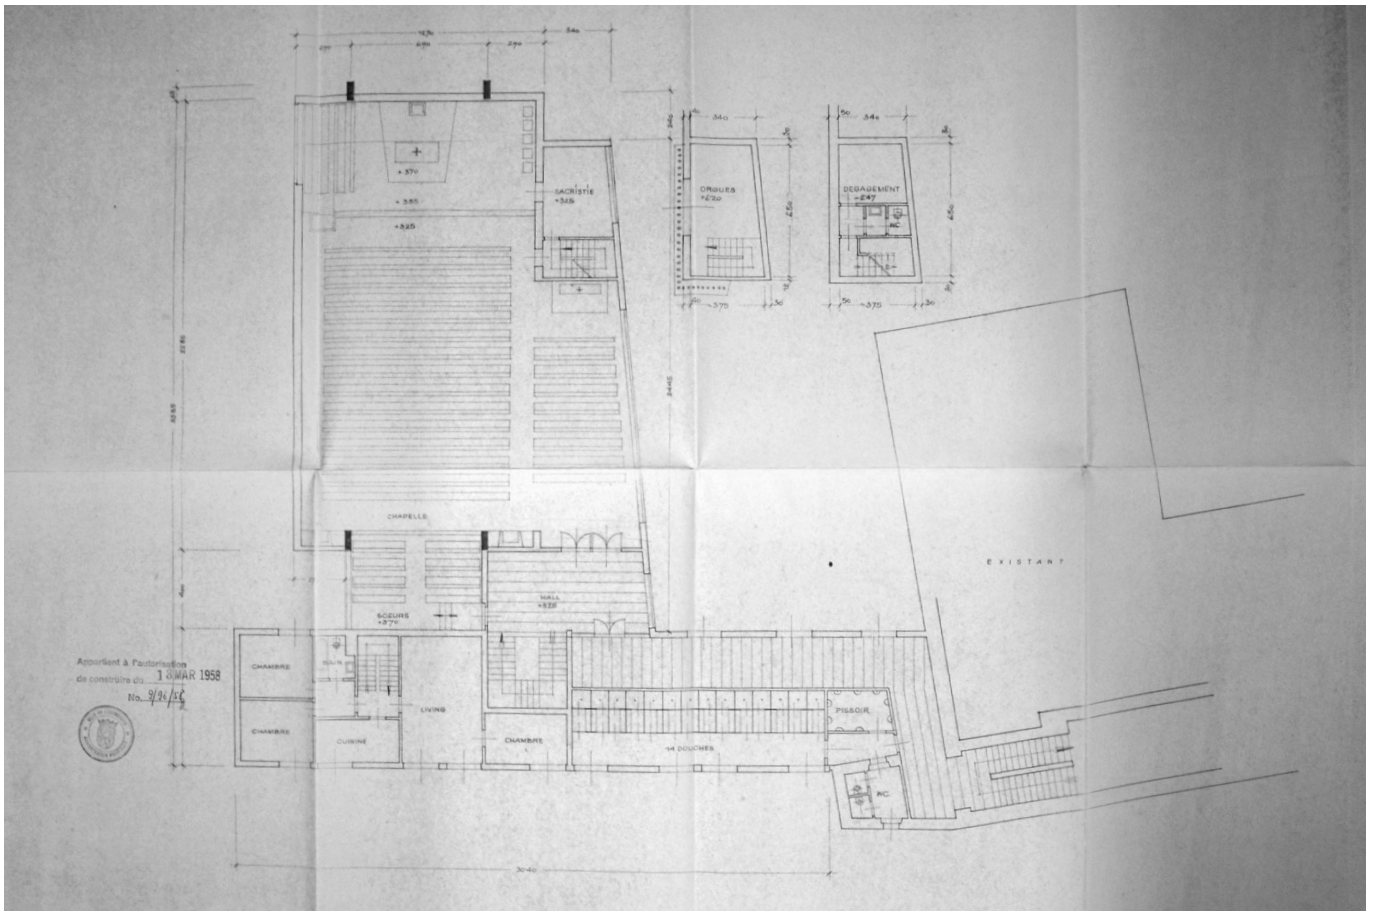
Grundriss, I. Obergeschoß (1958)
